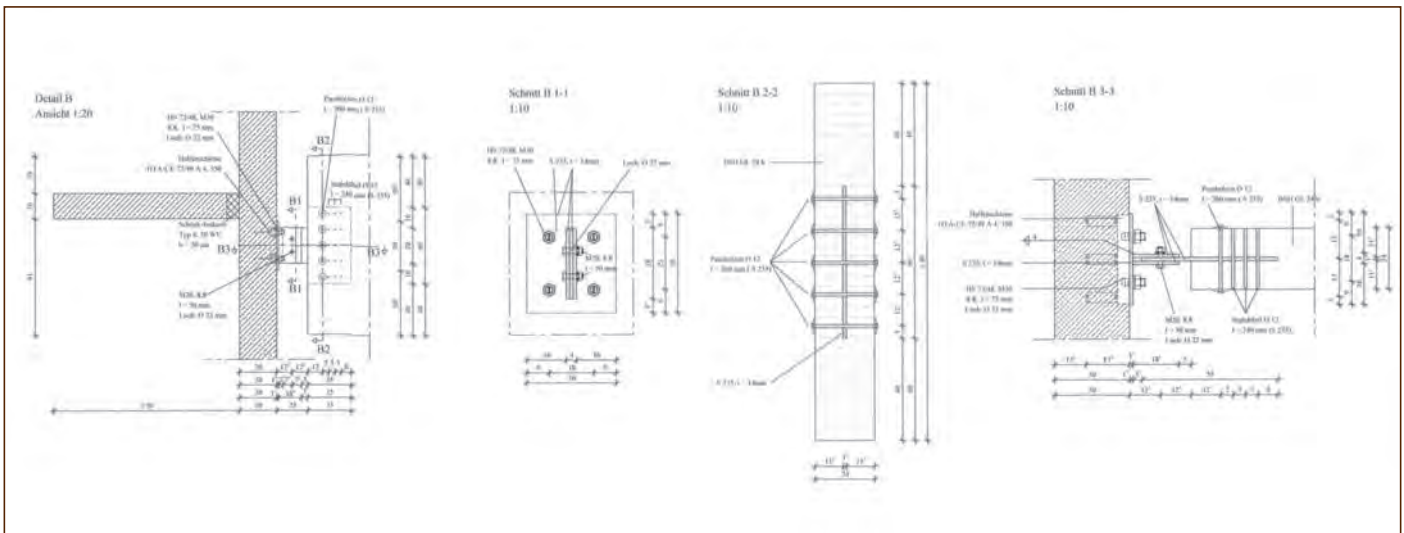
Details Anschluss Deckenbalken an Wand, Projekt 2 – Sporthalle WS 2014/15, Verfasser: Arne Wittenborn (Bachelor Architektur) und Michael Adeling (Bachelor Bauingenieurwesen), betreut an den Lehrstühlen Baukonstruktion und Stahlbau
